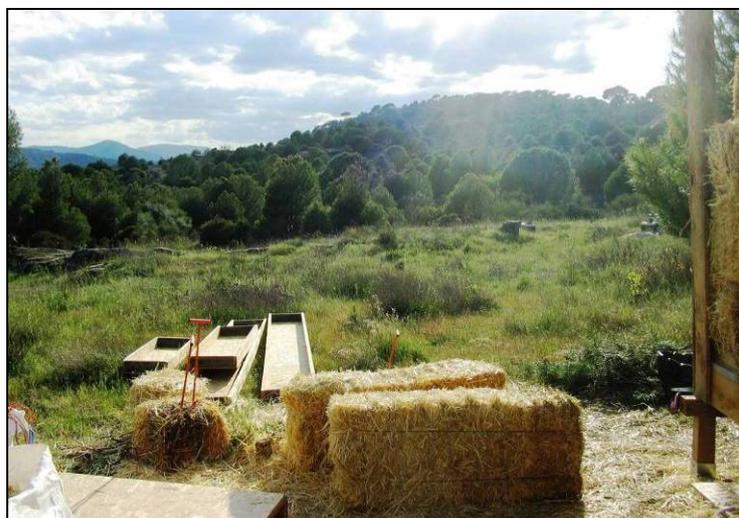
Balas de paja preparadas para construir. Taller Karuna. *Fotografía: Silvia Cenzano.
